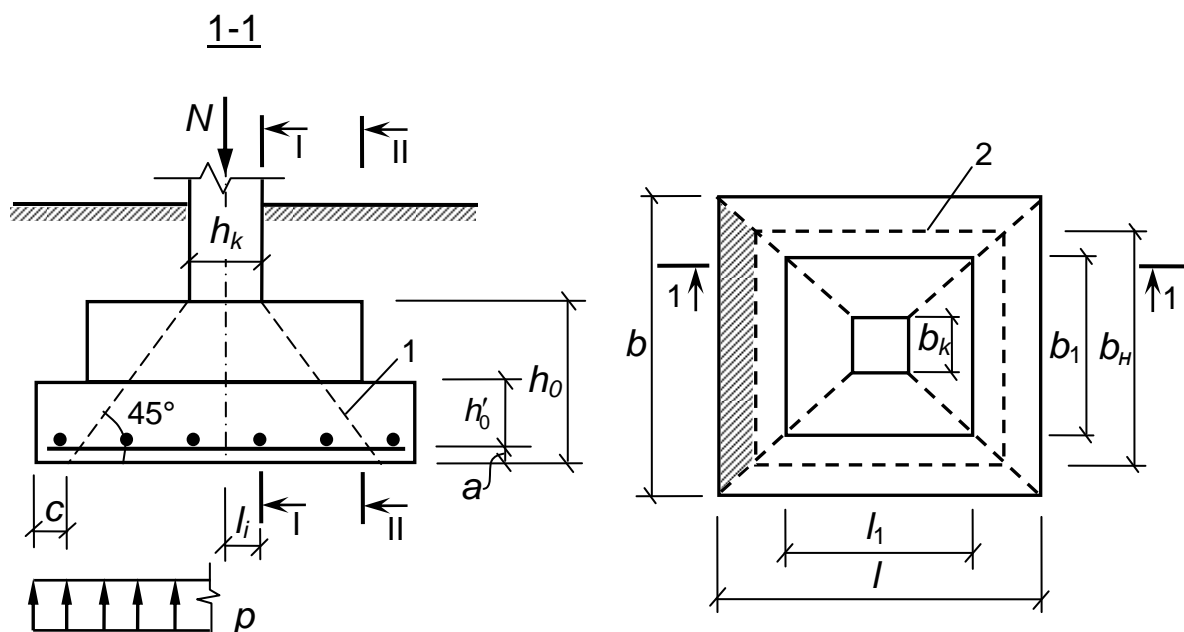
Схема к расчету отдельного фундамента: пирамида (1) и основание продавливания (2)
